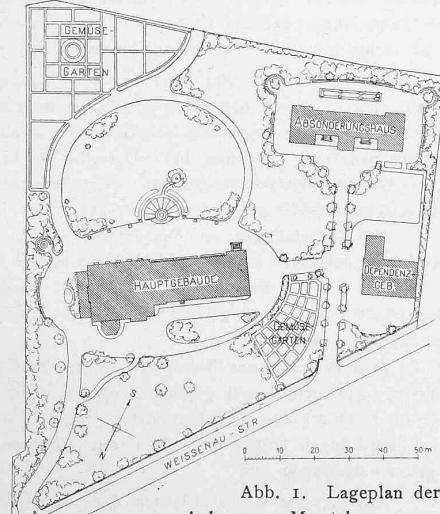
Lageplan der Anlage. — Masstab 1:2000.
